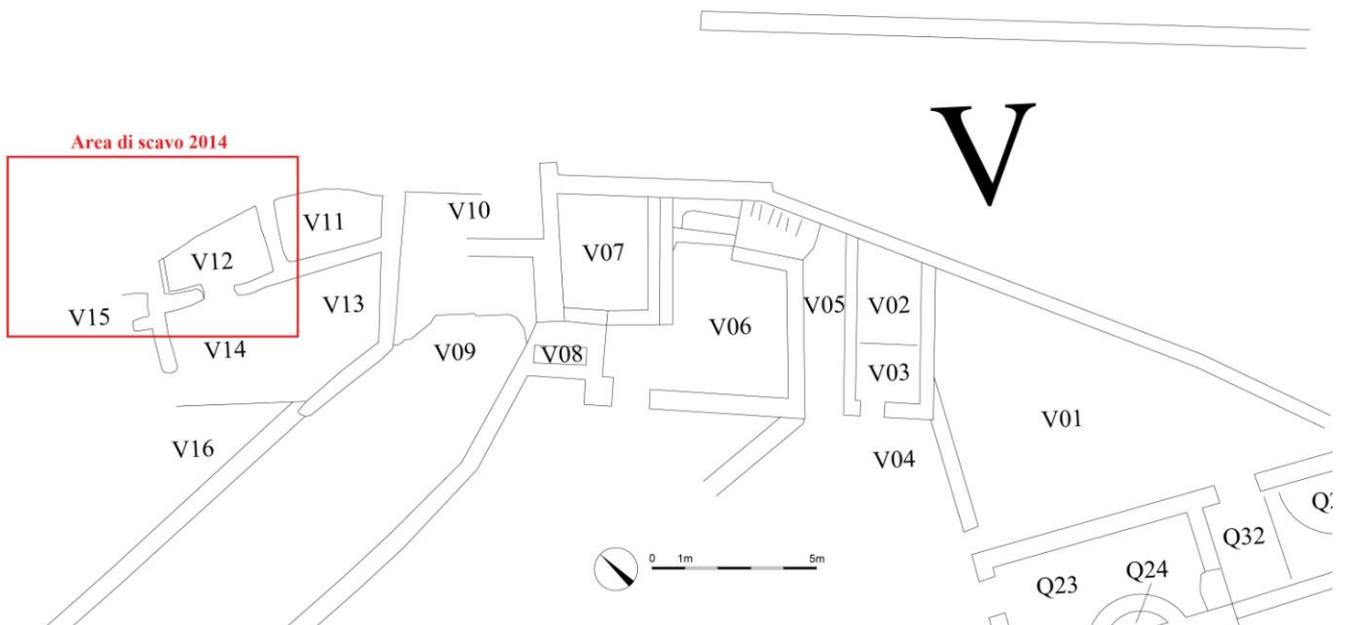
Sperlonga, Area V. Planimetria con indicazione dell'area di intervento.
